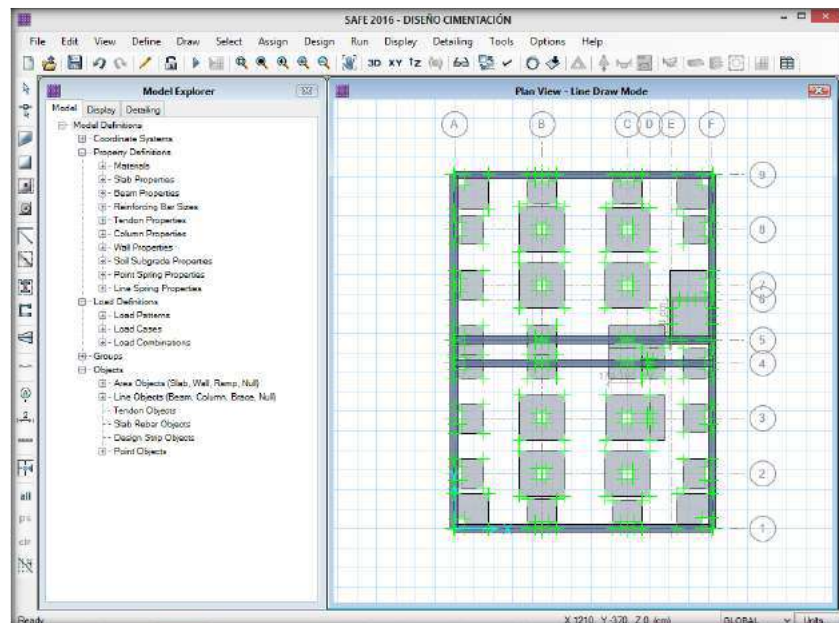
Definiendo la carga para las vigas de cimentación.
